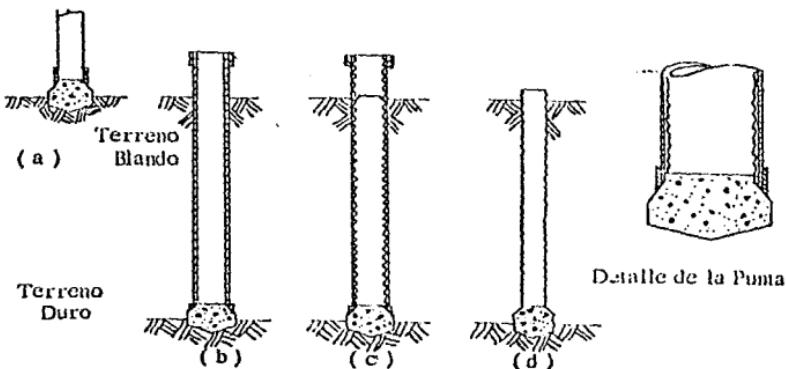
PILOTE BUTTON-BOTTOM.
